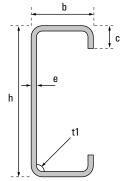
Exemple de configurations étudiées des pannes en profilés métalliques minces de forme en C
